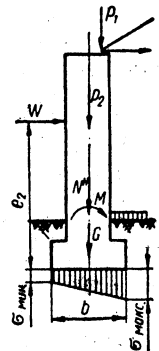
Расчетная схема стены (столба) здания с упругими опорами.
